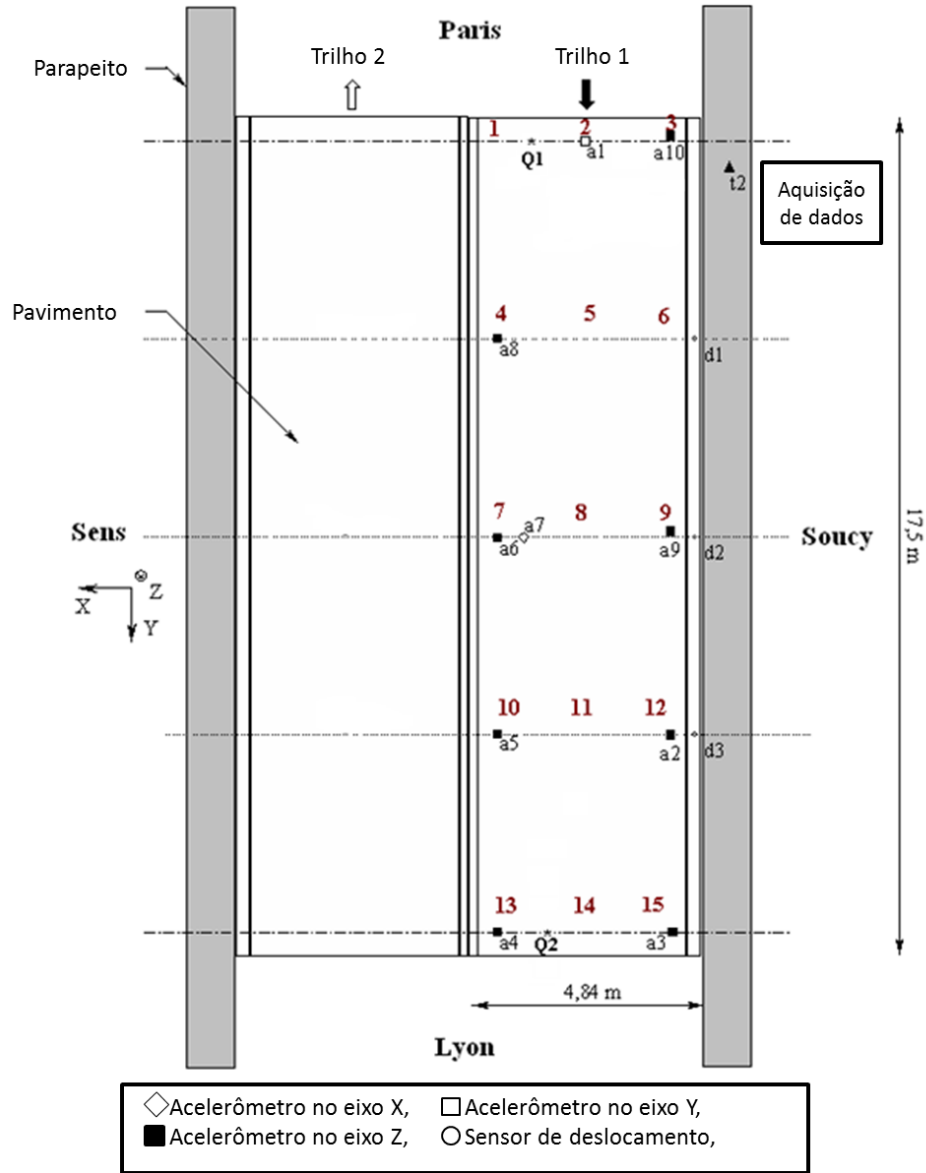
Disposição dos sensores sob o pavimento. FONTE – CURY, 2010.
